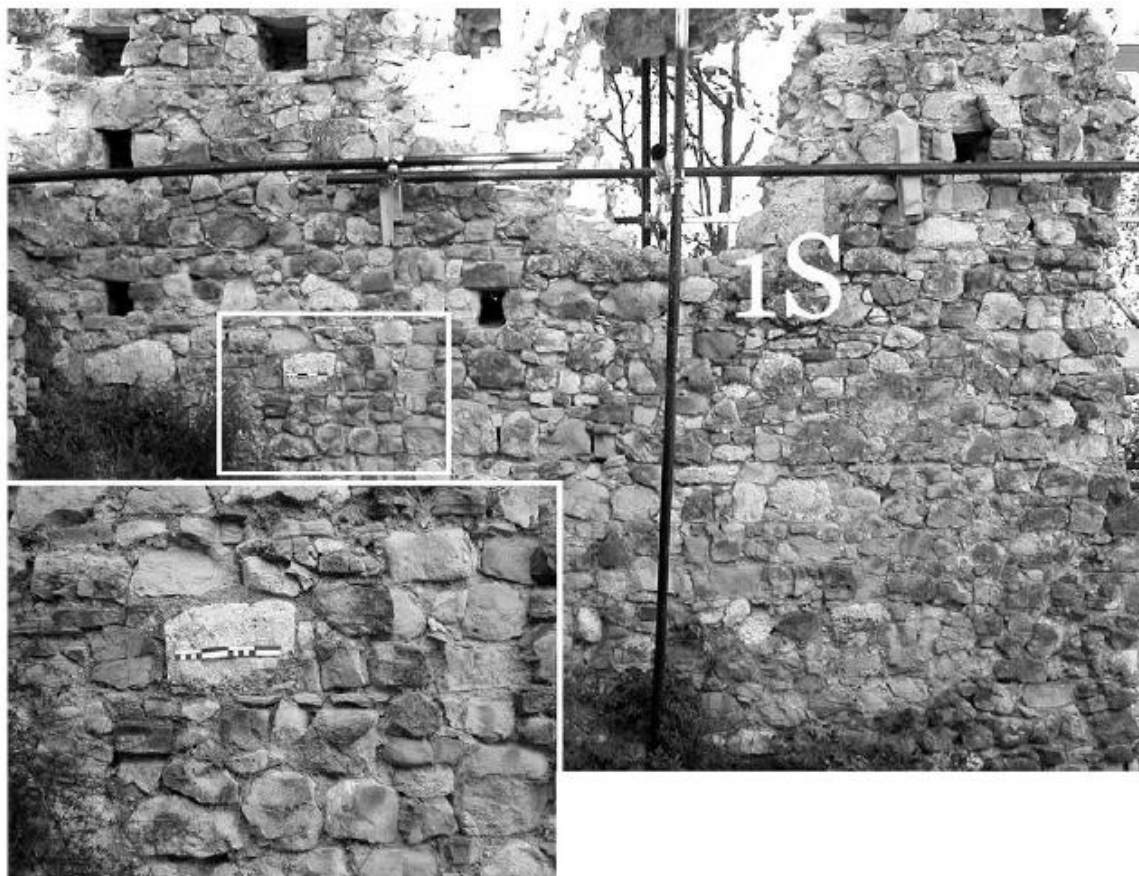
c. Una delle sezioni murarie della Rocca (da AQUILANO 2010).
